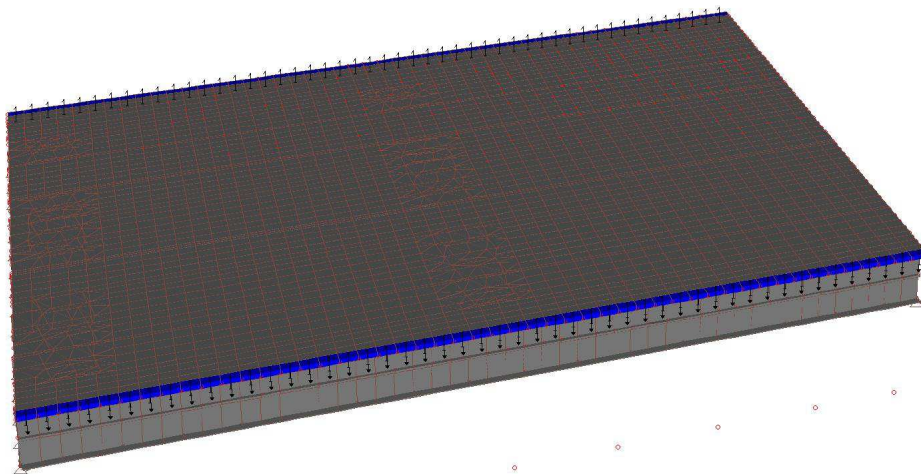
Disposizione carico trasmesso da parapetto
